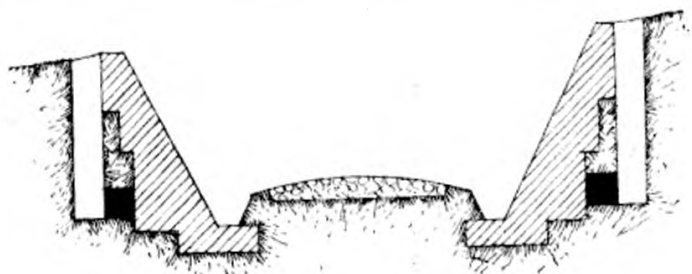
Dispositif d'obstruction d'une route en déblai.
